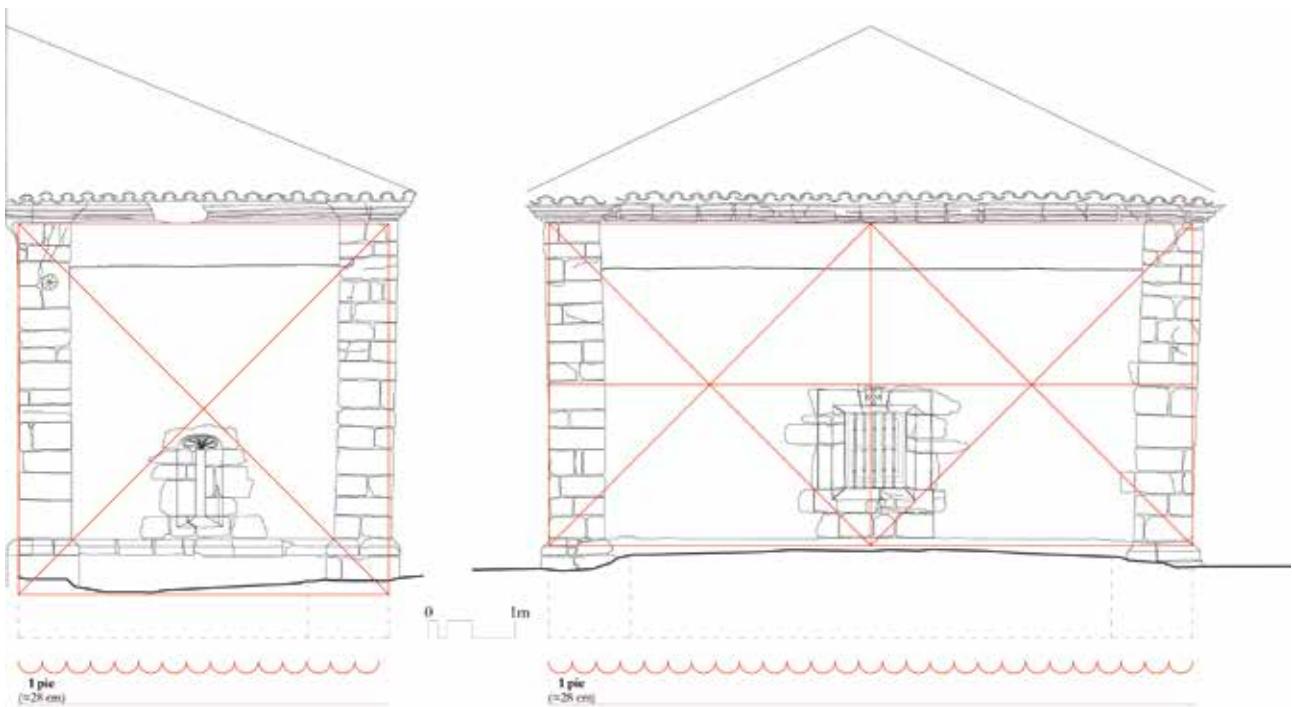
Proporción de los alzados. Izquierda: alzado lateral (1/1). Derecha: alzado trasero (2/1). (David Ordóñez Castañón).
